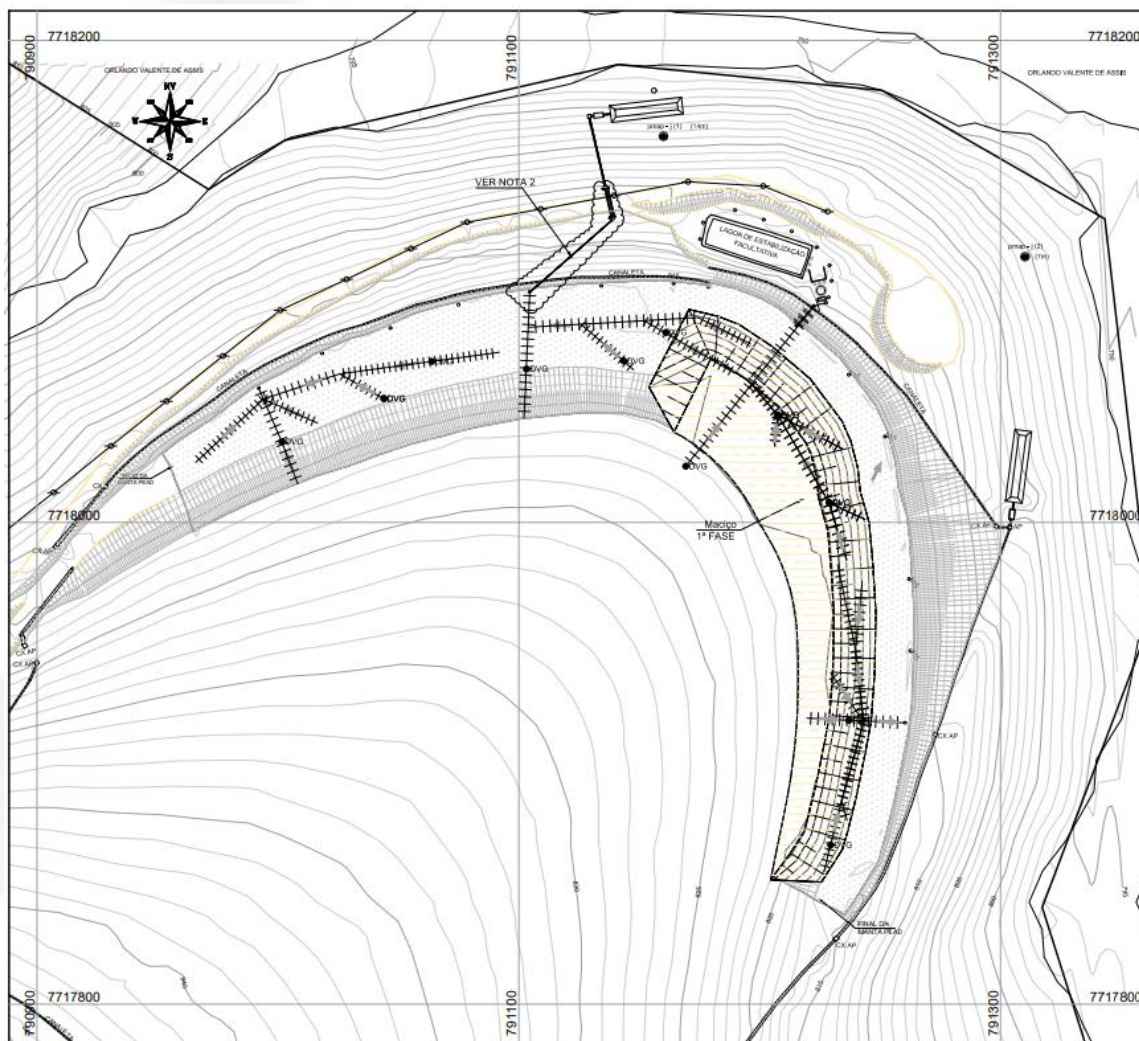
Planta da plataforma 1: aterro maciço 1ª fase e drenagem de fundo 2ª fase.
